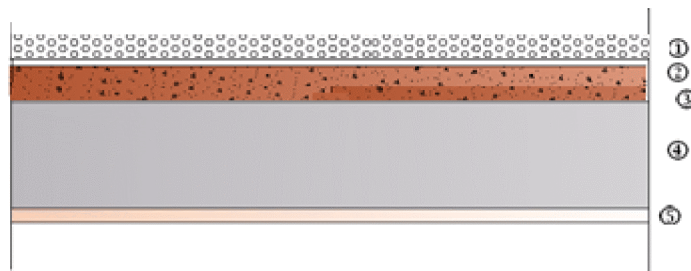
coupe verticale d'un plancher d'étage courant
